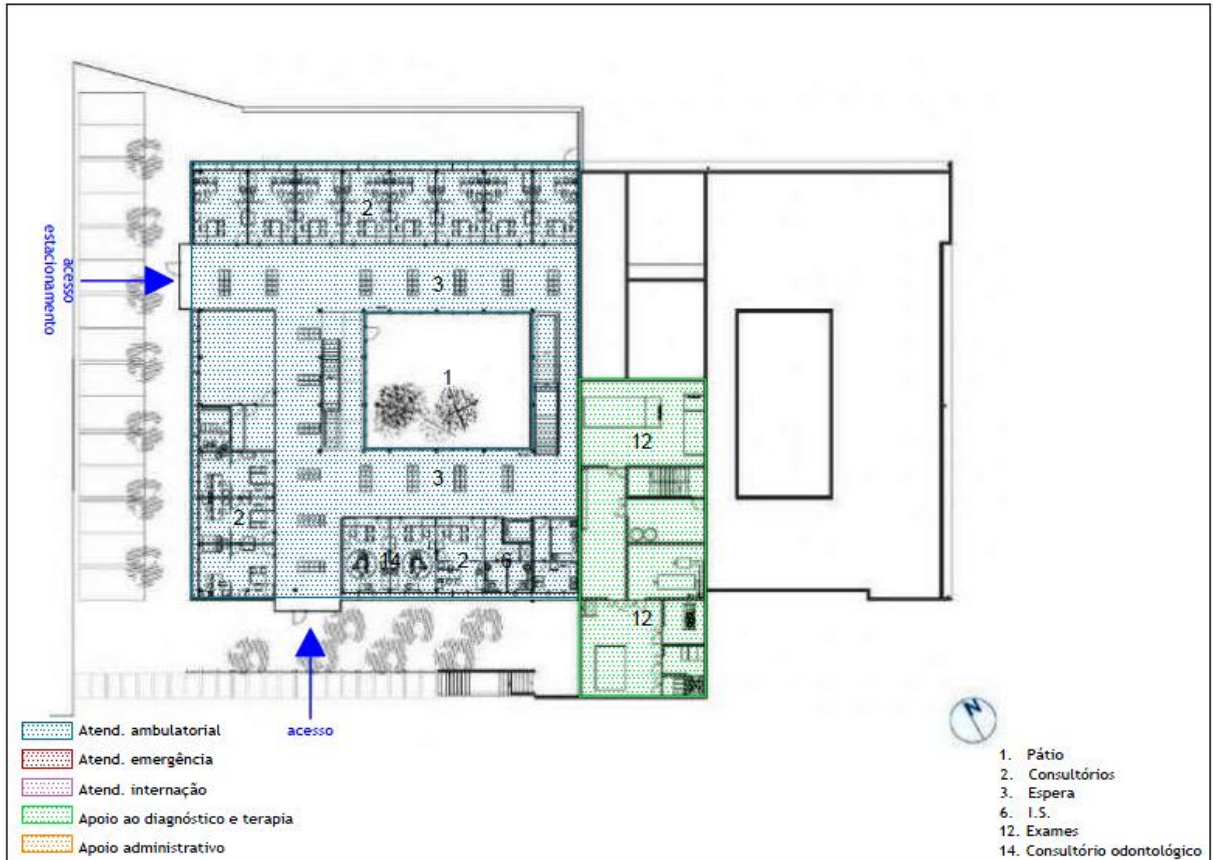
Planta pavimento inferior (FONTE: ROSENBERG, 2011), adaptado
